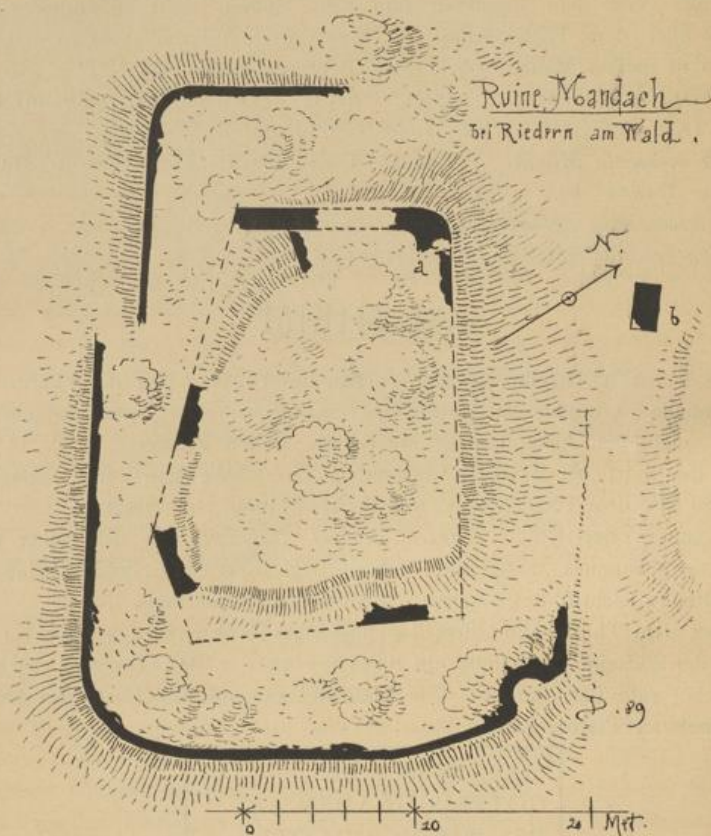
Mandach. Grundriss der Burgruine.
